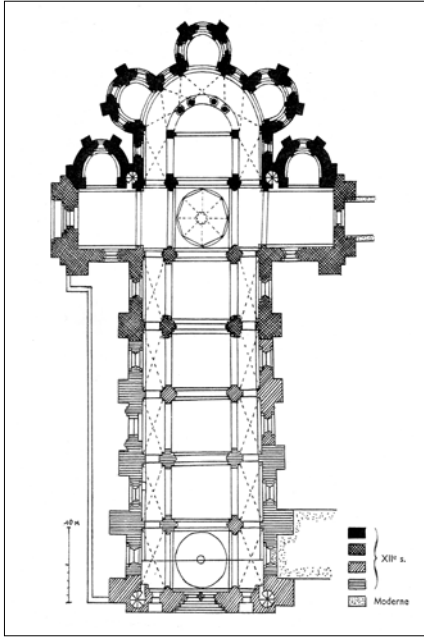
Planimetria da igreja de St. Pierre-ès-Liens, Le Dorat.
